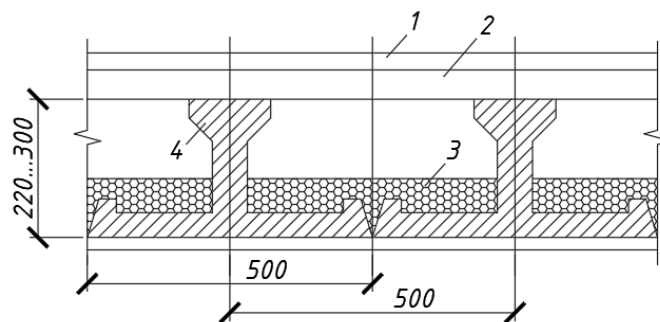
Конструкції для заміни перекриттів з залізобетонними балками-настилами двотаврового перетину: 1 - дерев'яна підлога; 2 - дерев'яні лаги; 3 - утеплювач; 4 - балка-настил
